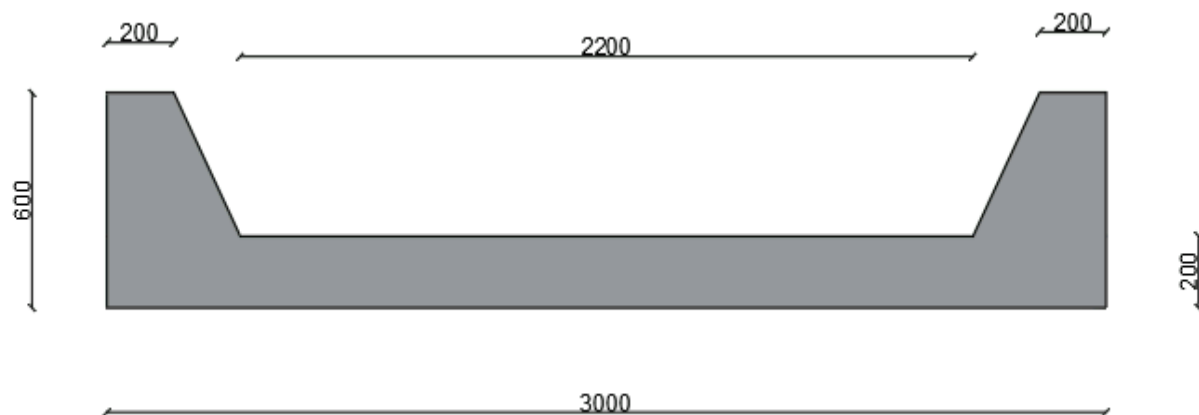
Sección de la cuneta de la berma intermedia. Fuente: Elaboración propia.
